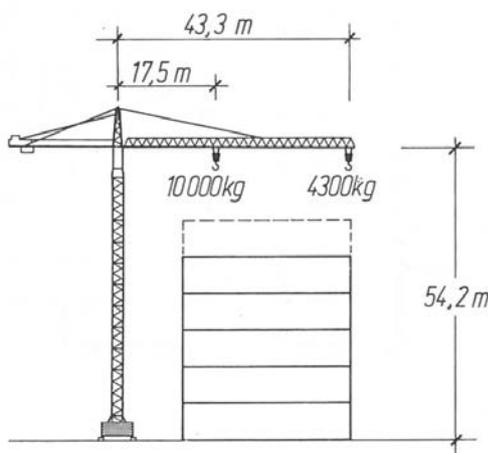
Horizontale Montage mit Turmdrehkran, geschossweise (Bachmann, Steinle und Hahn 2009)
